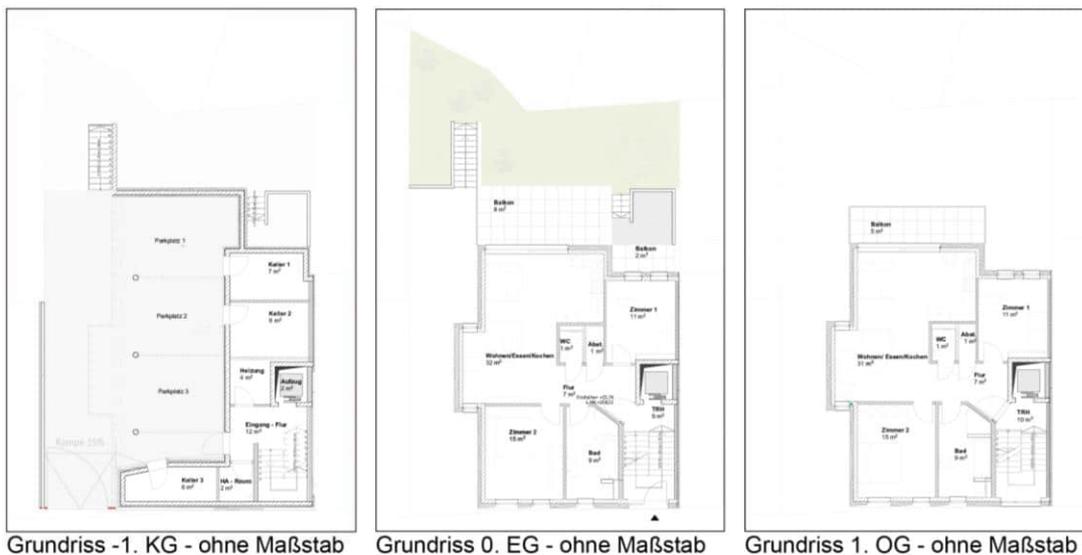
Grundrisse (KG, EG, 1. OG) KM Architekten (Quelle: KM Architekten)
